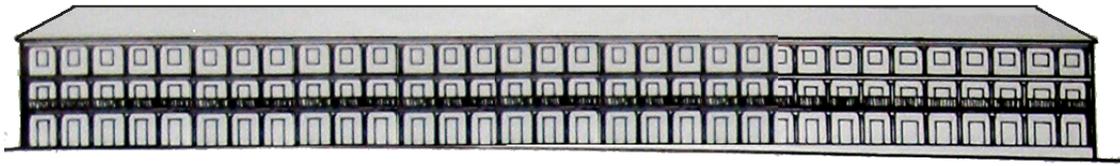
Fachada del costado occidental de la plaza con el edificio de las Galerías Arrubla (Corradine).
